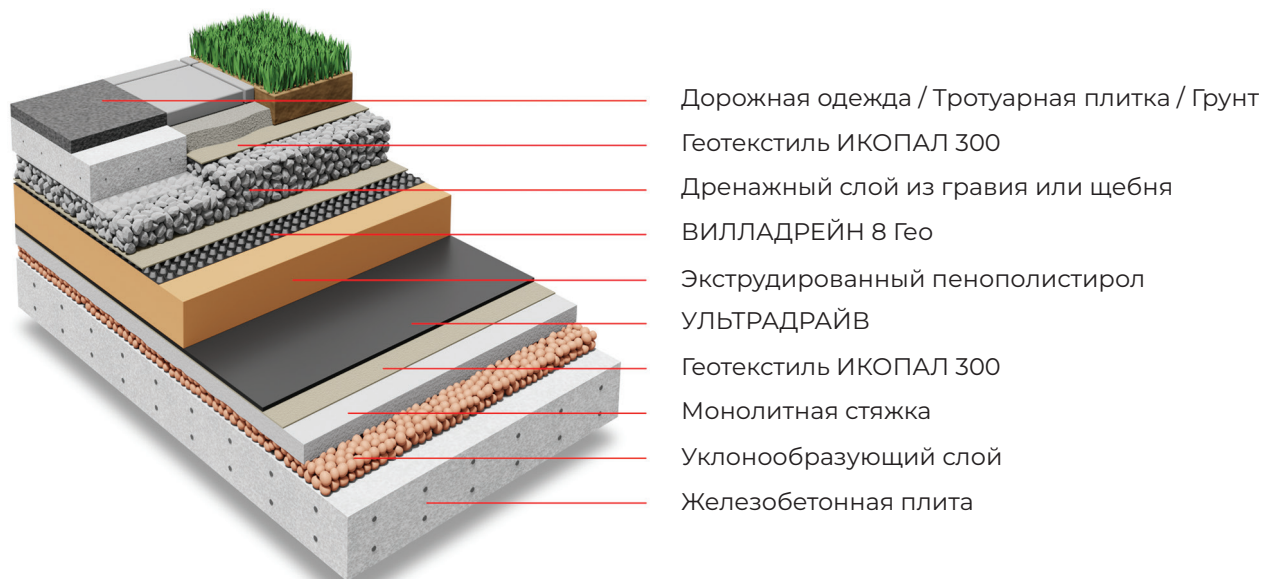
Вариант инверсионной эксплуатируемой кровли с однослойным кровельным ковром
